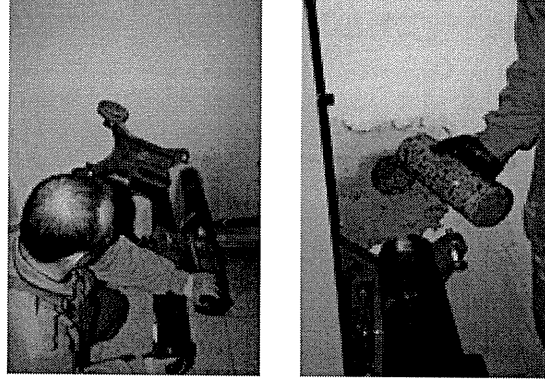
Ara kattaki betonarme perdede donatı tespiti
